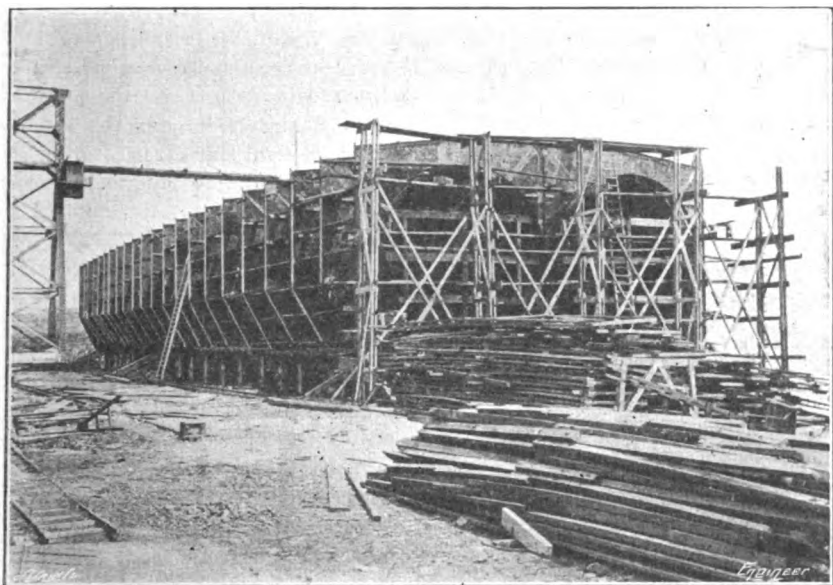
Tunnel sotto il Detroit River - Vista di una sezione in costruzione.
